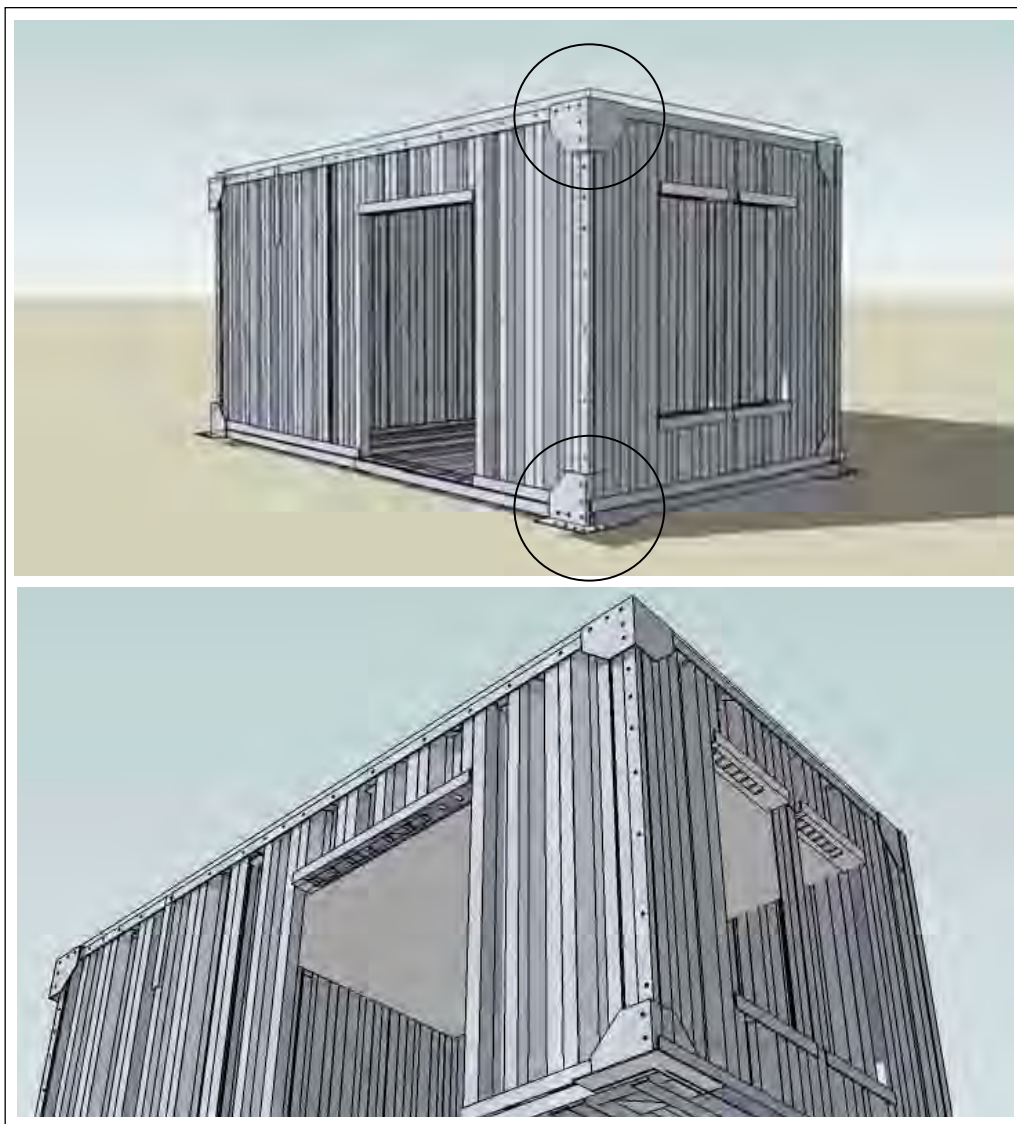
Vistas de los refuerzos en los vértices. Fuente: Elaboración propia. 2008
